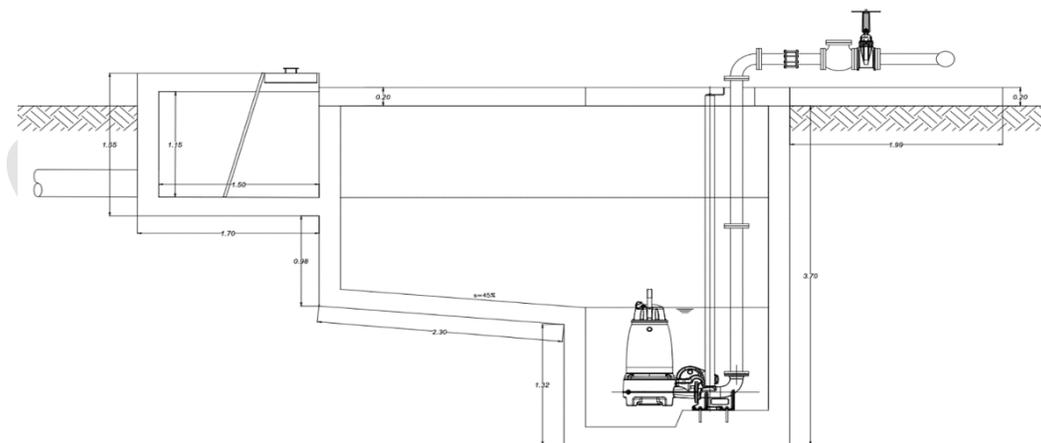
Conjunto de la Planta General de la "Construcción del Cárcamo de Bombeo".
